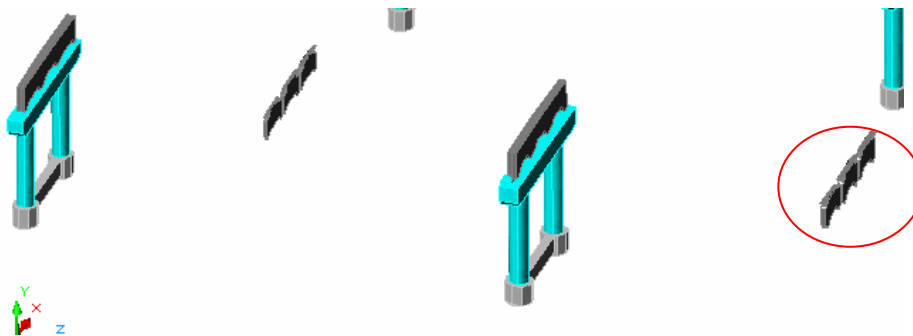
VIGAS TRANSVERSALES (0,25X1,00 m.) EN TRAMOS DE 30 METROS, 1 UNIDAD LADO IZQ. Y 1 UNIDAD EN EL LADO DERECHO.
